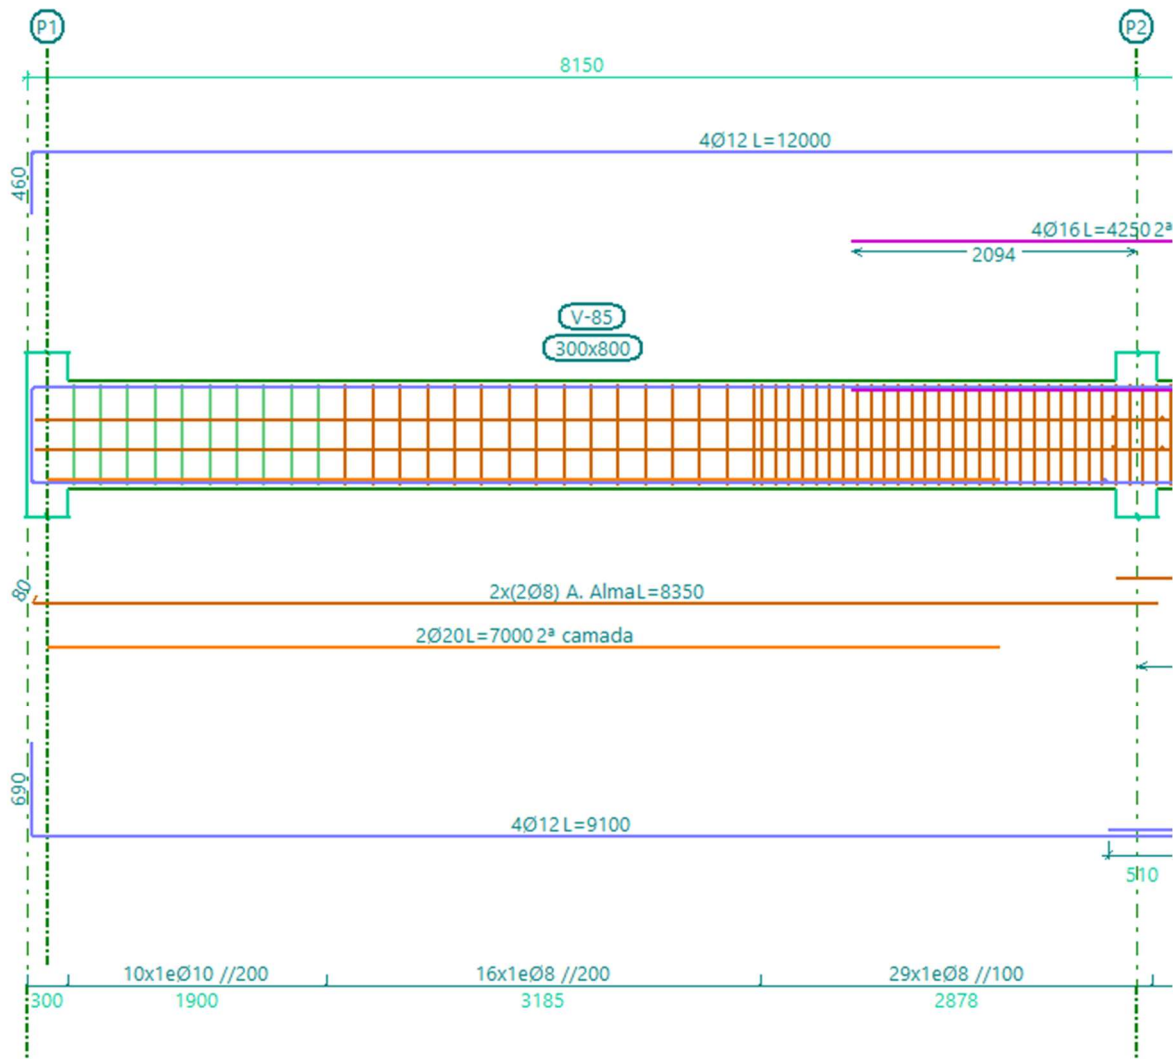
armadura longitudinal da viga calculada pelo software
